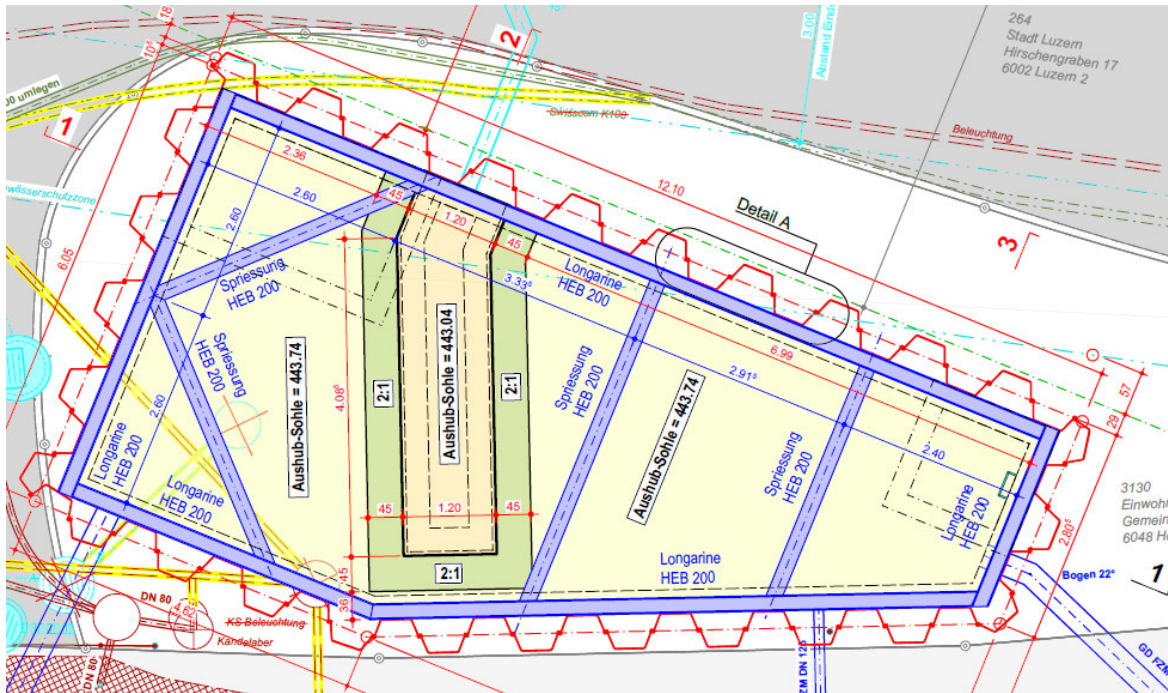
Grundriss Spundwand mit Stahlsprissung
